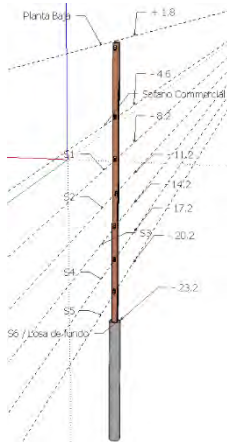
Perfil pre-cimentados en pila de cimentación con nivel de losa y perfiles en la primera fase de excavación.
